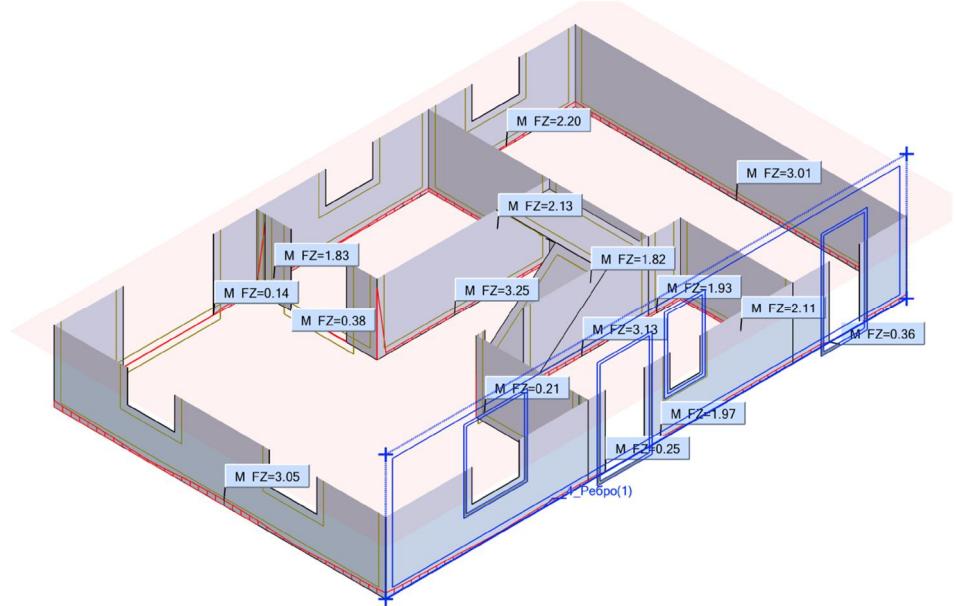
Расчетная линейная нагрузка на ленту фундамента по СОМВ 2, т/м
